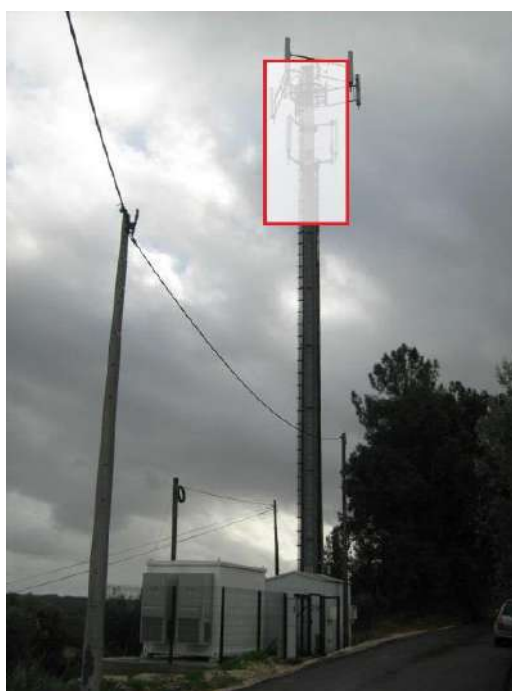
Ilustração de um monopolo de geometria semelhante ao do caso em análise
